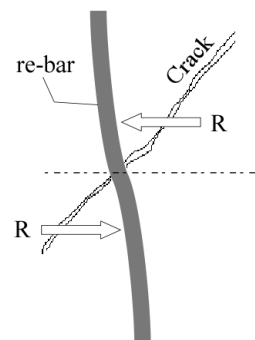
ひび割れ面を横切る補強筋によるダボ抵抗
